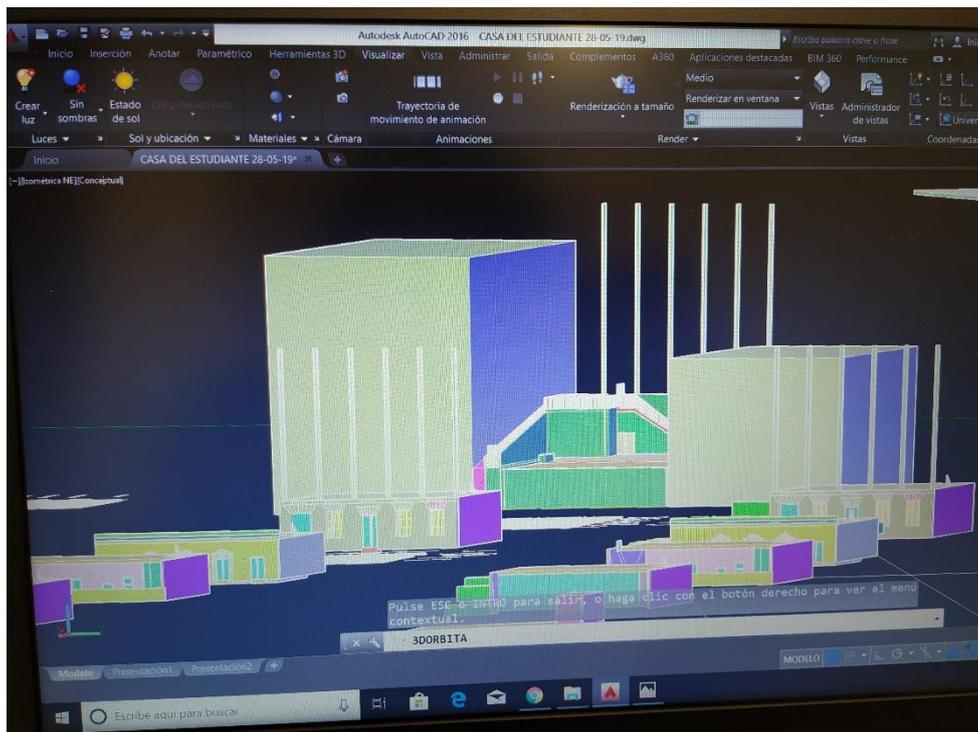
Modelado AutoCAD - Unión Plantas AutoCAD. Casa del Estudiante
